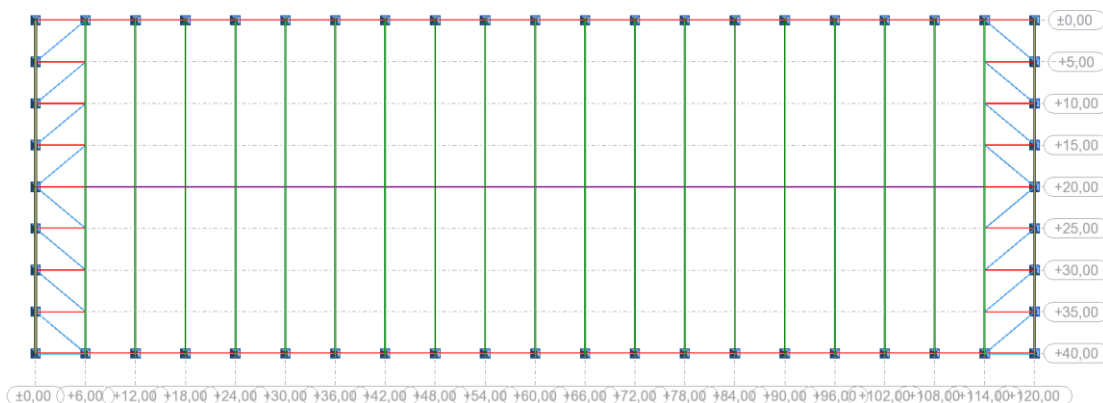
Exemplo da diferença de perfis aplicados no contraventamento em pórticos treliçados - vista em planta (caso de estudo T40-6)
